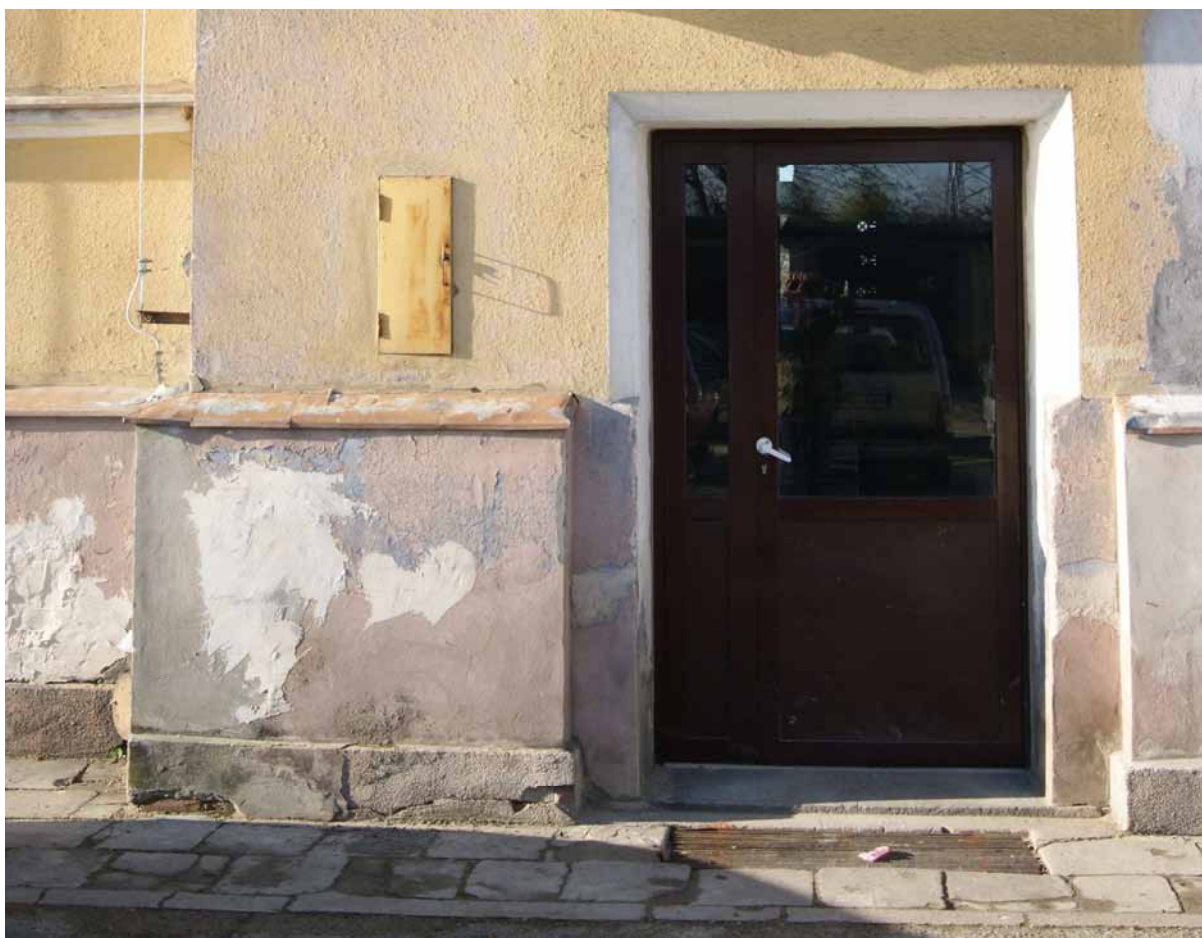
Odspojenia tynków elewacji tylnej wschodniej w sąsiedztwie rury spustowej przy ryzalicy
